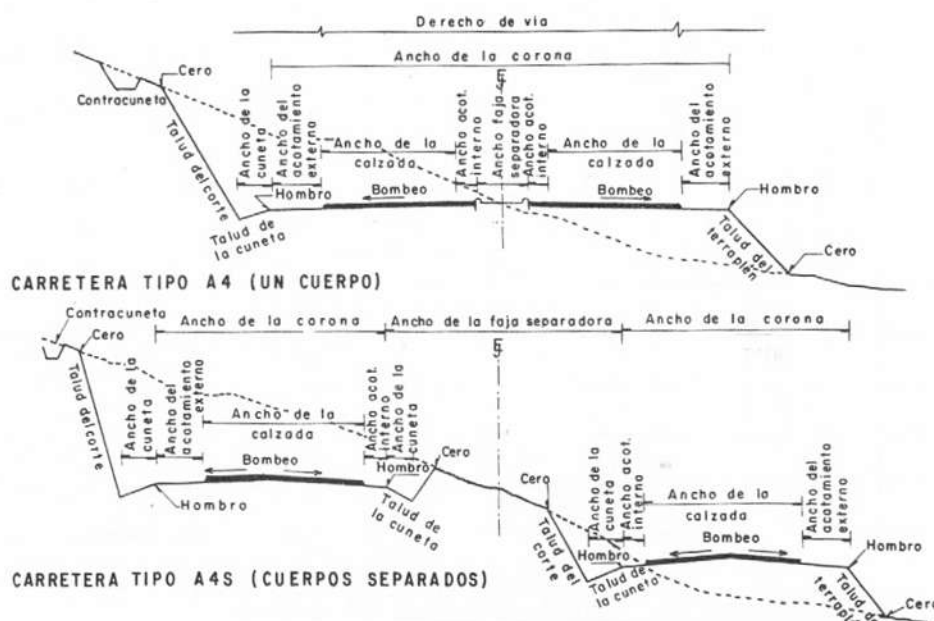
Sección transversal en tangente del alineamiento horizontal para carreteras A4
